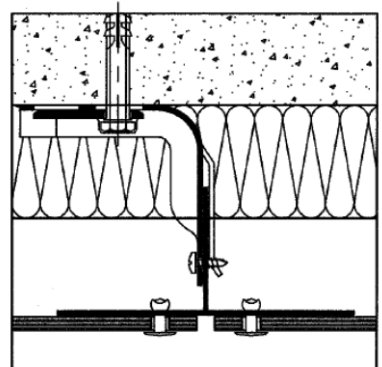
Buitenhoek (horizontale doorsnede)
